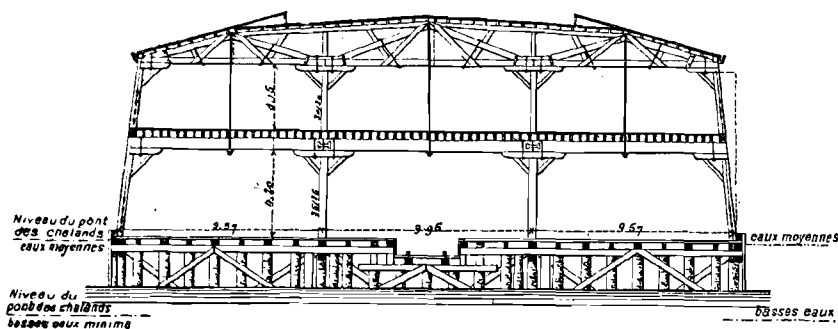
Coupe transversale des hangars E et F représentés en plan sur la planche CXXIX.
